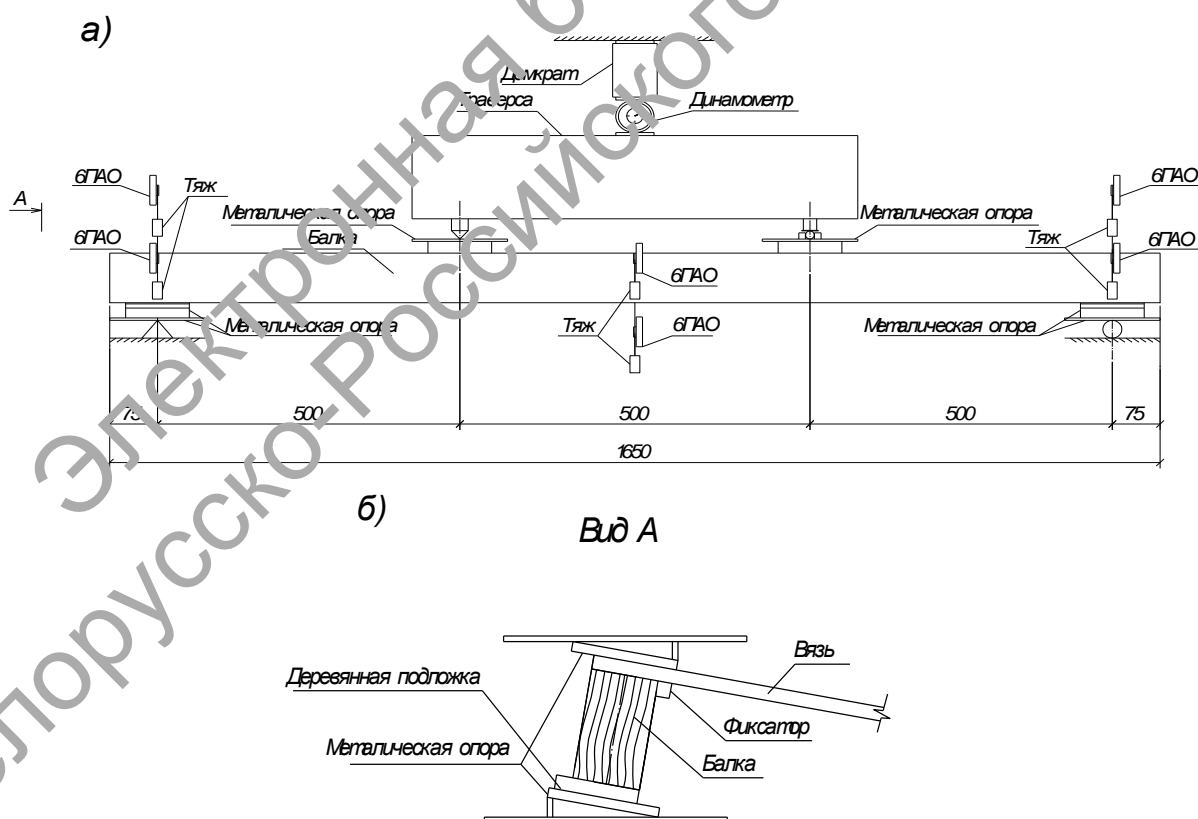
Схема опытной установки испытания: а – расположение измерительных приборов; б – вид А
